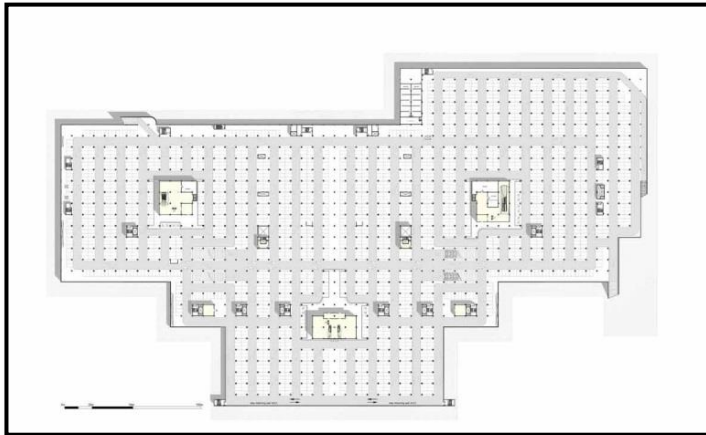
Plan du 2<sup>ème</sup> sous-sol
